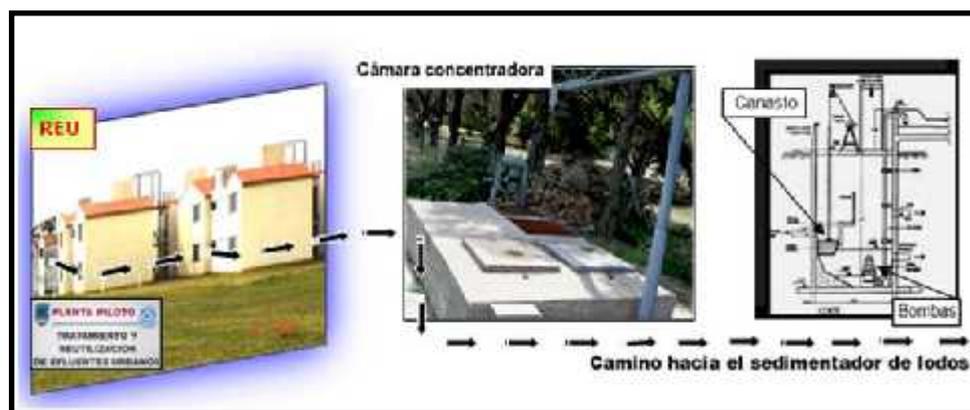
Conducción de los efluentes y pre-tratamiento. Planta Piloto. UNRC.
